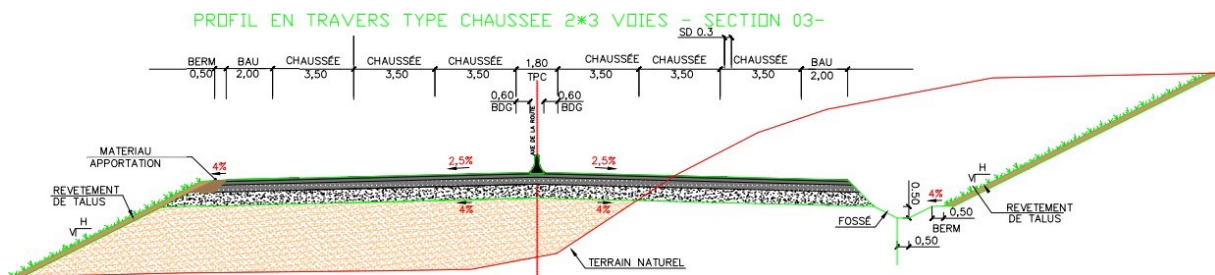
Profil en travers type chaussée 2x3-section 03.
